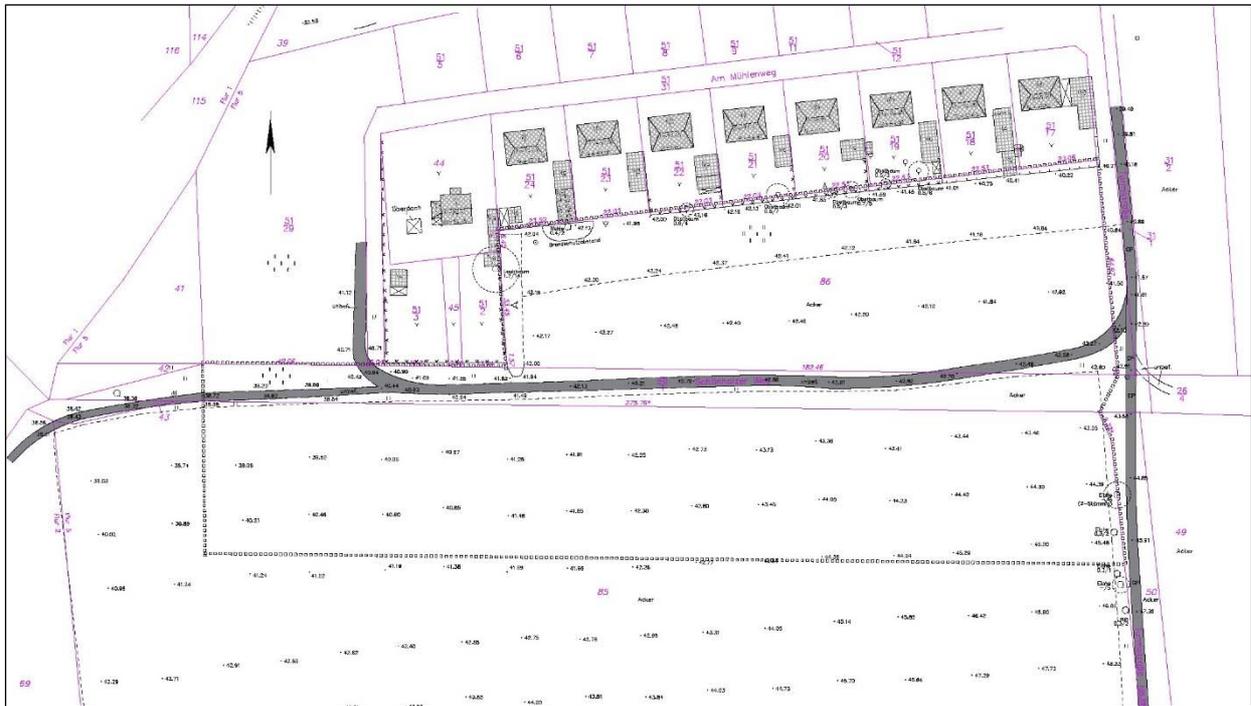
Geltungsbereich B-Plan "Schönholzer Weg / Turmstraße" in der Stadt Rhinow; (Grundlage Bestandsvermessung 04/2019; ohne Maßstab)
